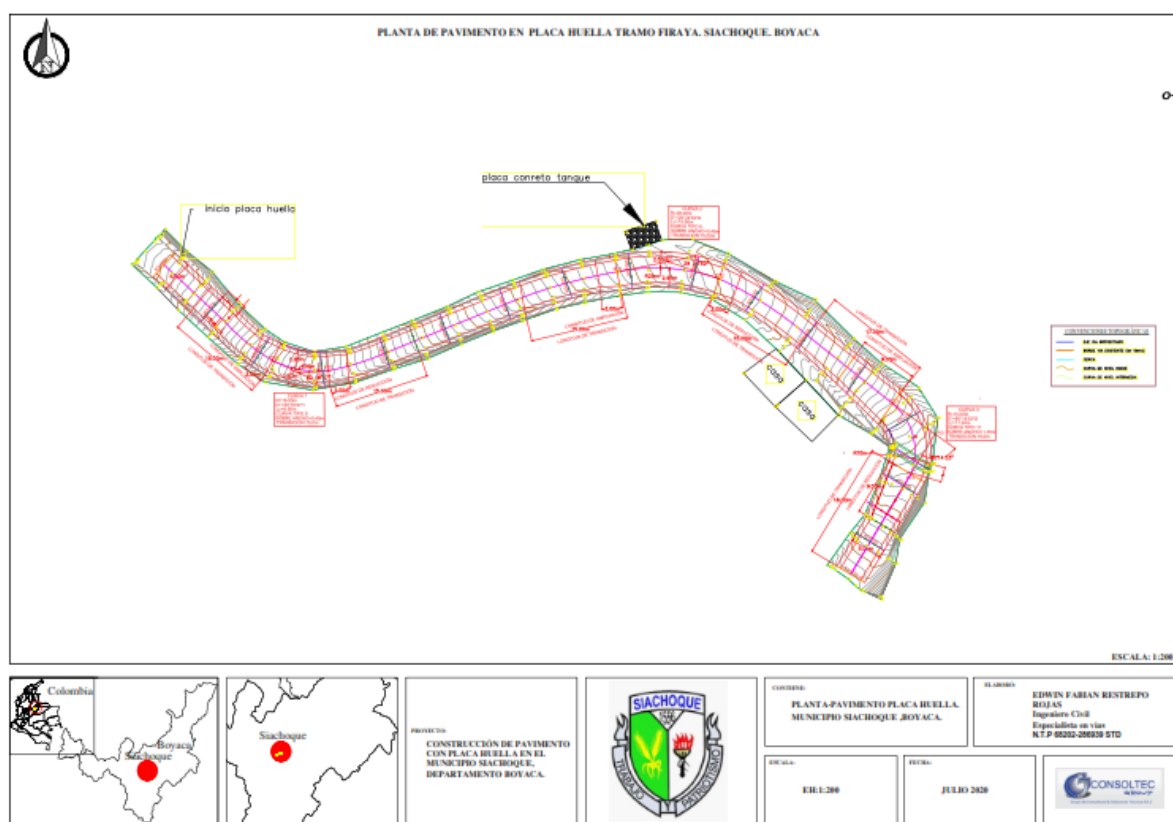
Planta de pavimento en placa-huella tramo Firaya, Siachoque, Boyacá
